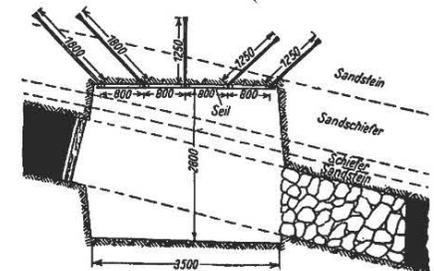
Disposition des boulons et du bosseymet dans la section équipée d'un revêtement mixte.
